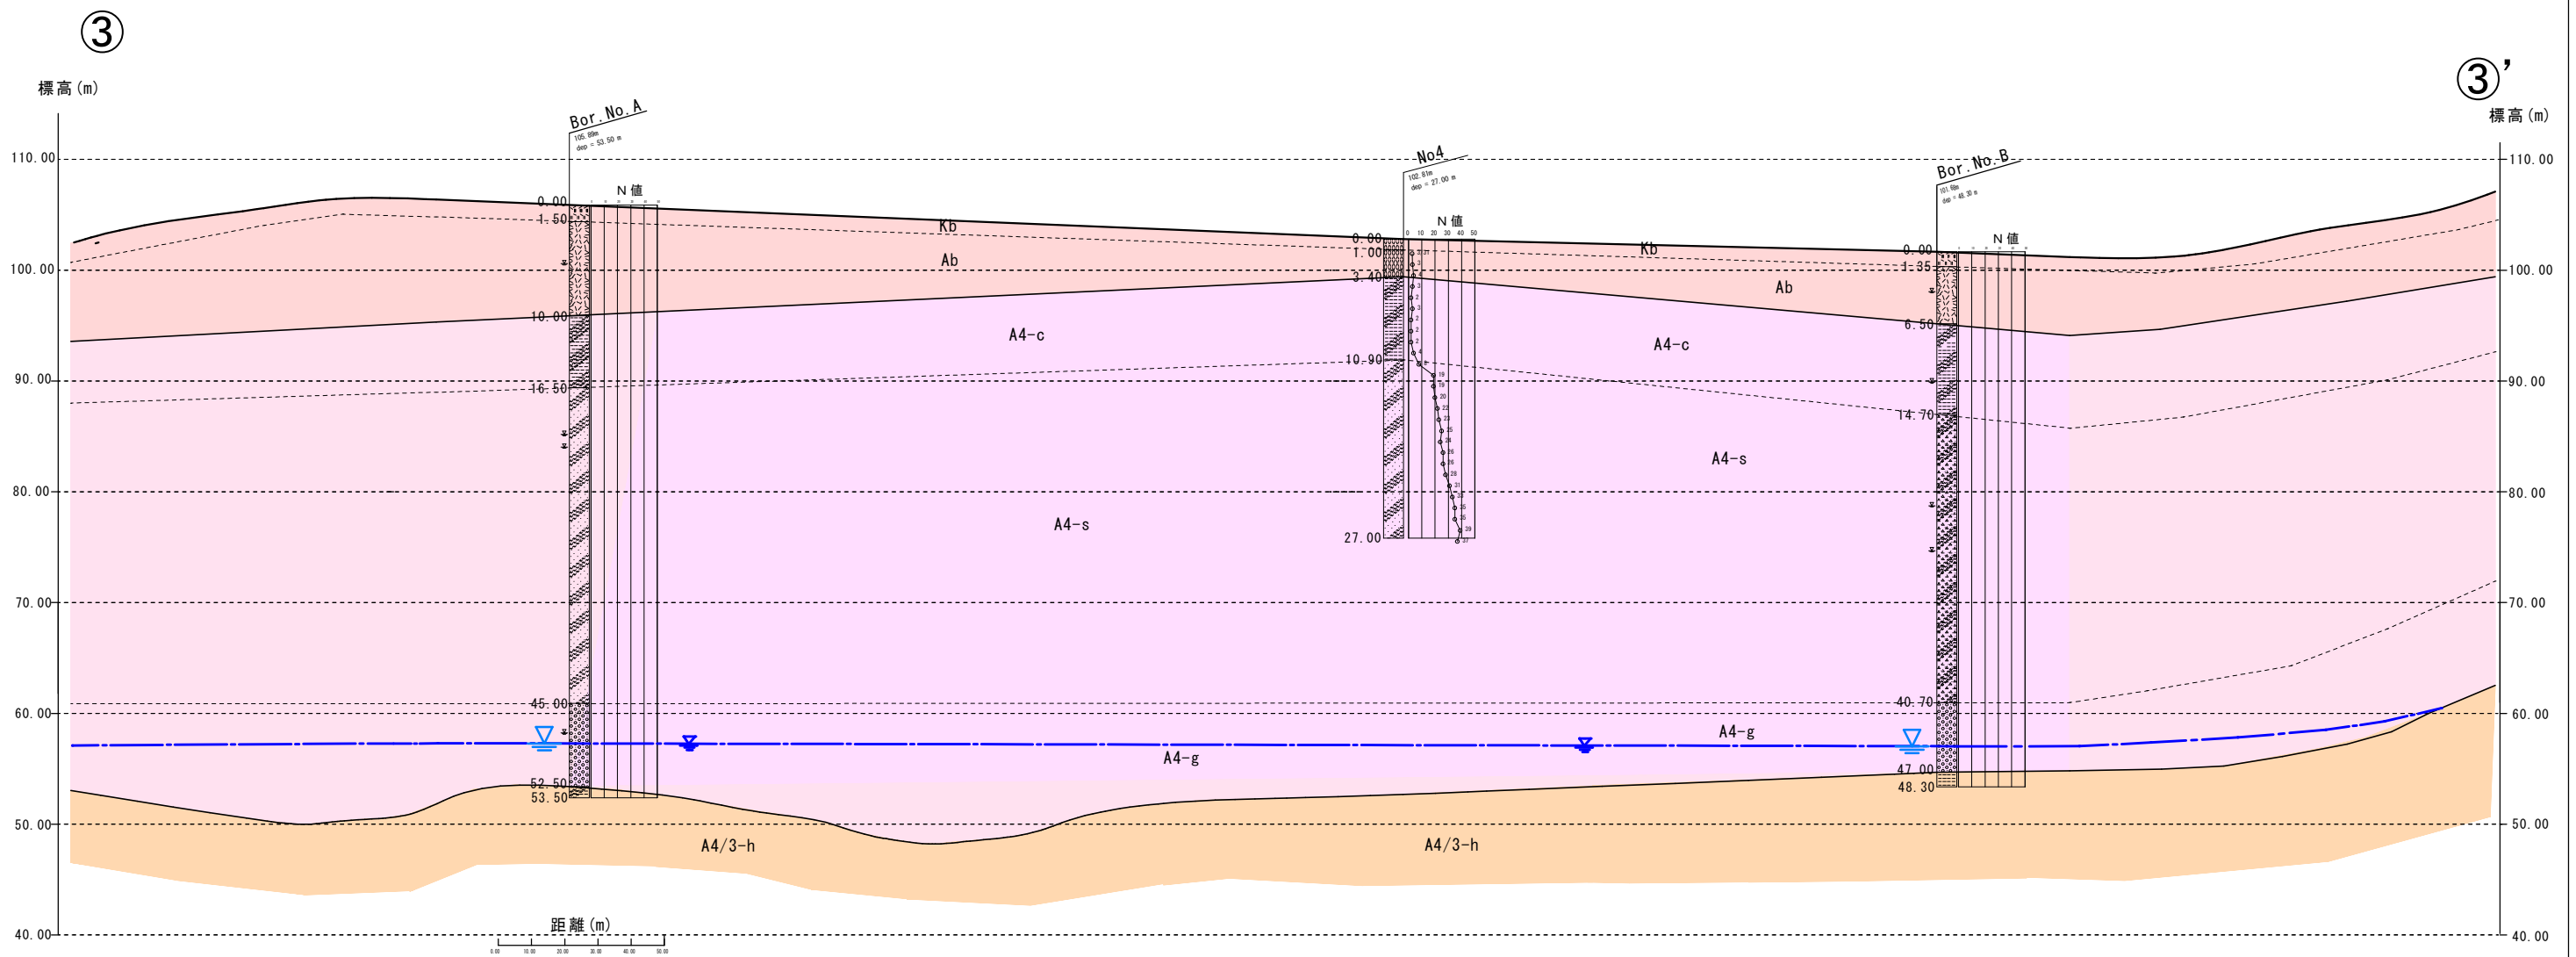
③-③' 地質断面図 (No. A~No. 4~No. B断面)
